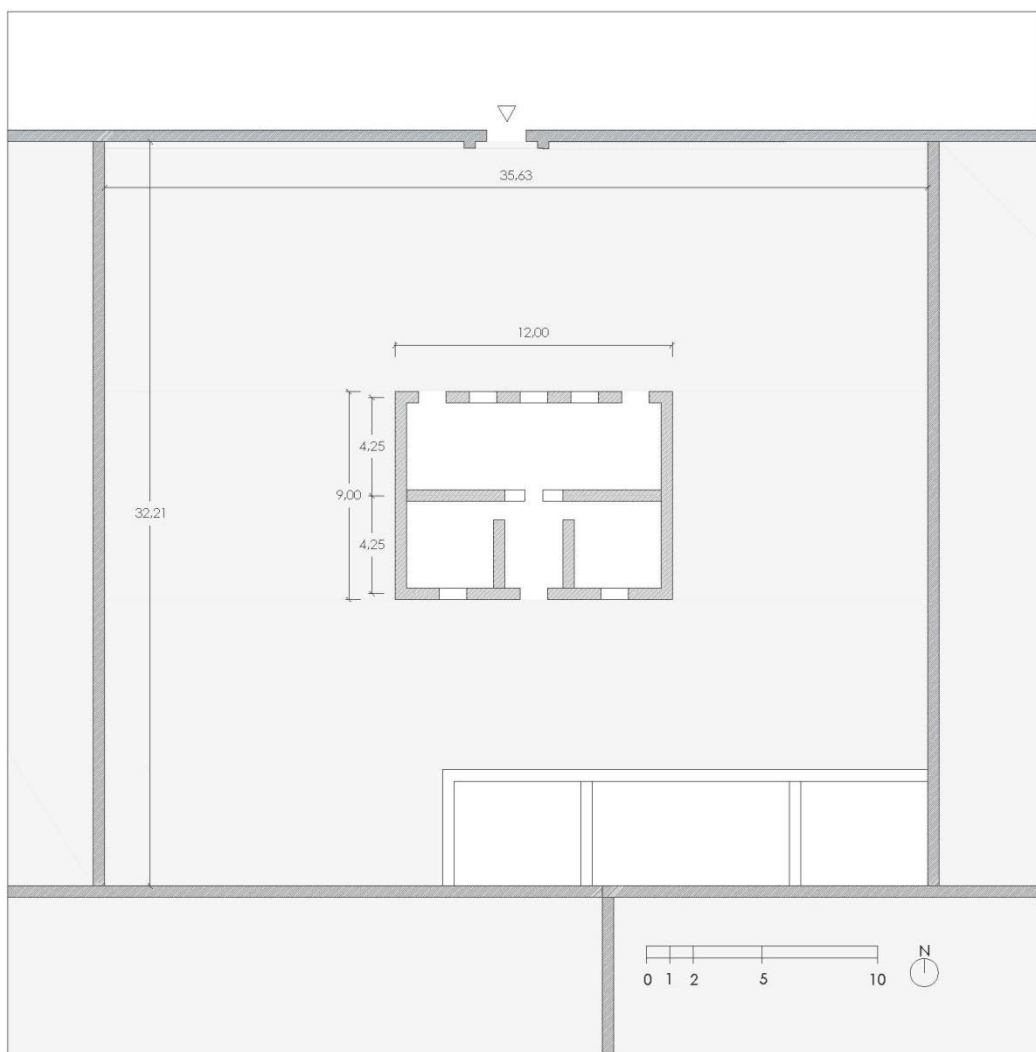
Planta vivienda. Fuente: elaboración propia.
